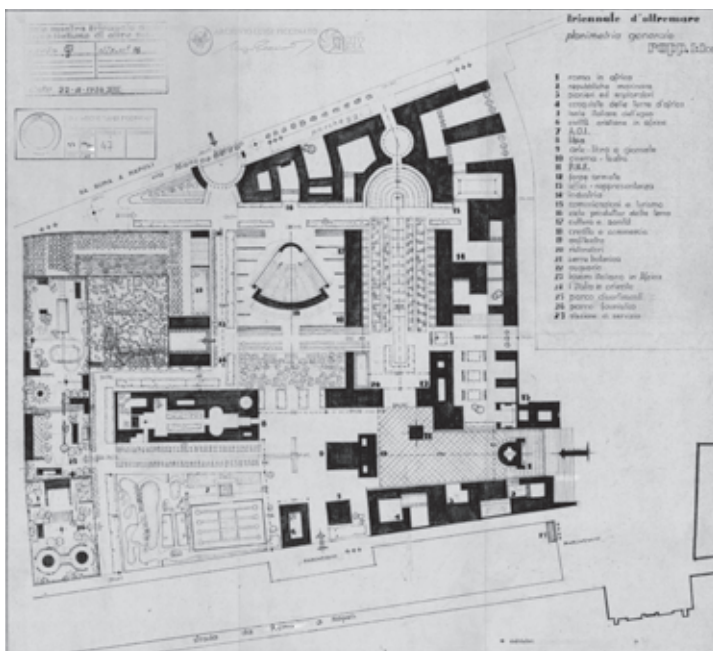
Studio planimetrico preliminare (Archivio Piccinato).
